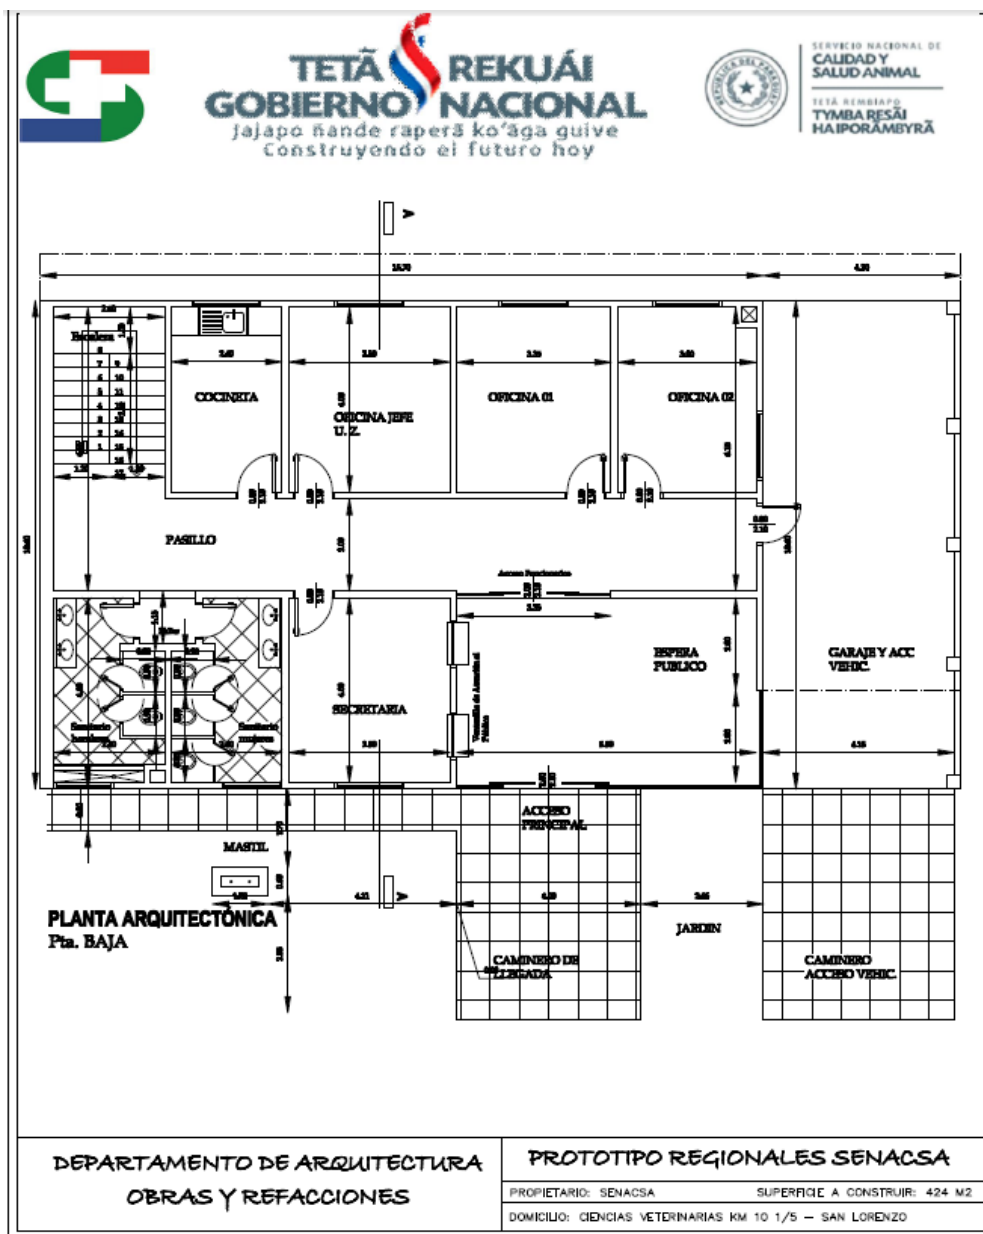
Plano correspondiente a la planta baja de una Oficina Regional
